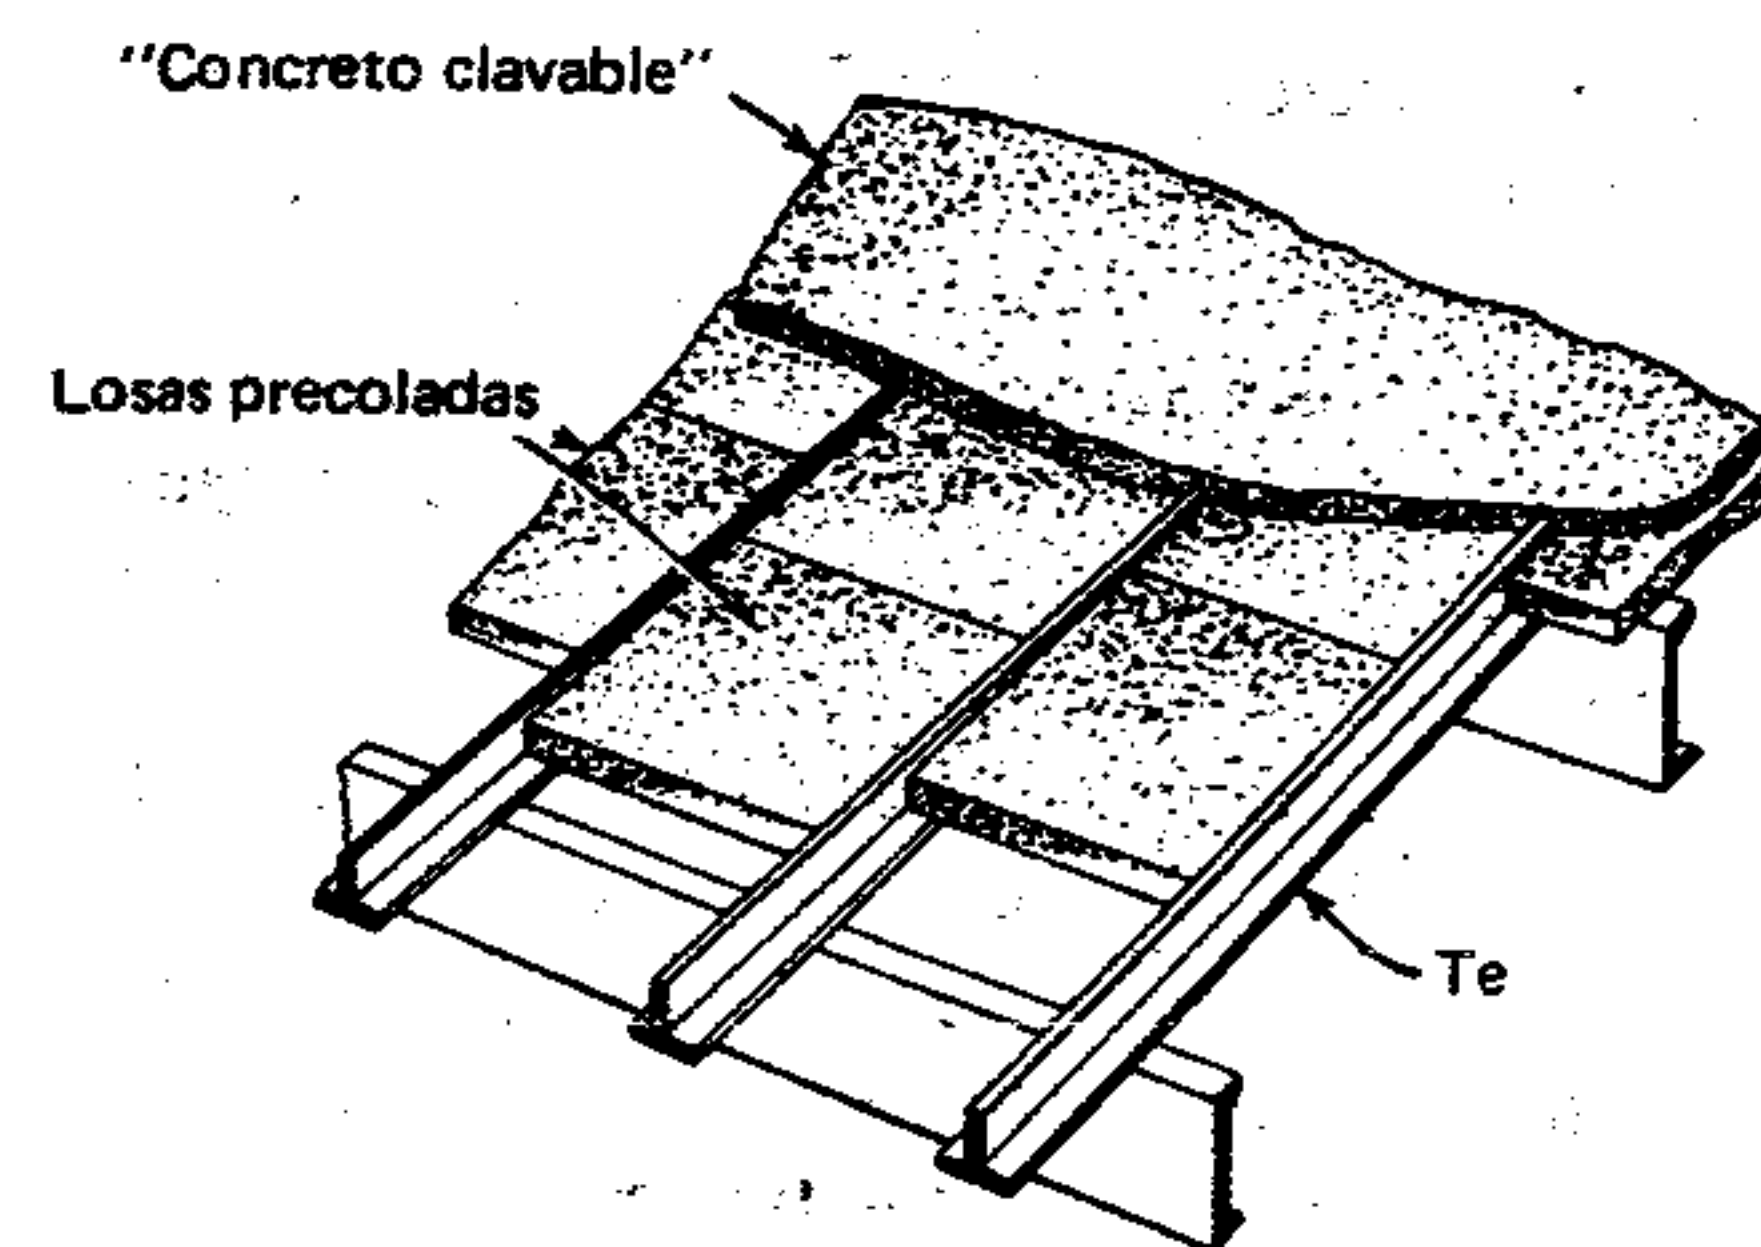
Losas precoladas apoyadas sobre sublargueros en te.
